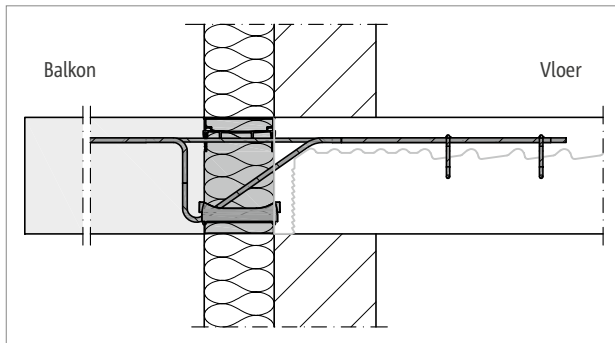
Schöck Isokorf® uitvoeringsvariant ID: Het Schöck Isokorf®-element kan bij het plaatsen van het balkon zijdelings worden verschoven. Hier worden de doorsneden van de trek- en dwarskrachtstaven van XT type K-ID-M3 getoond in de vloeruitsparingen.
